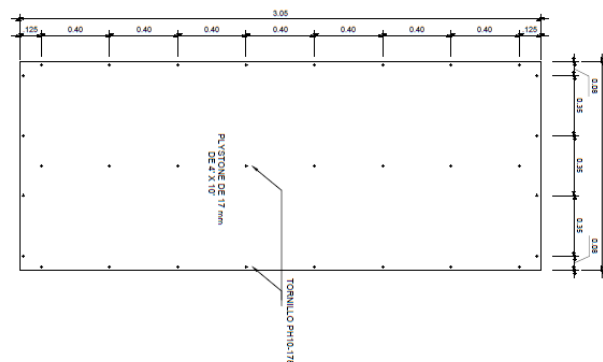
Esquema de armado de estructura en paneles 4 y 5
